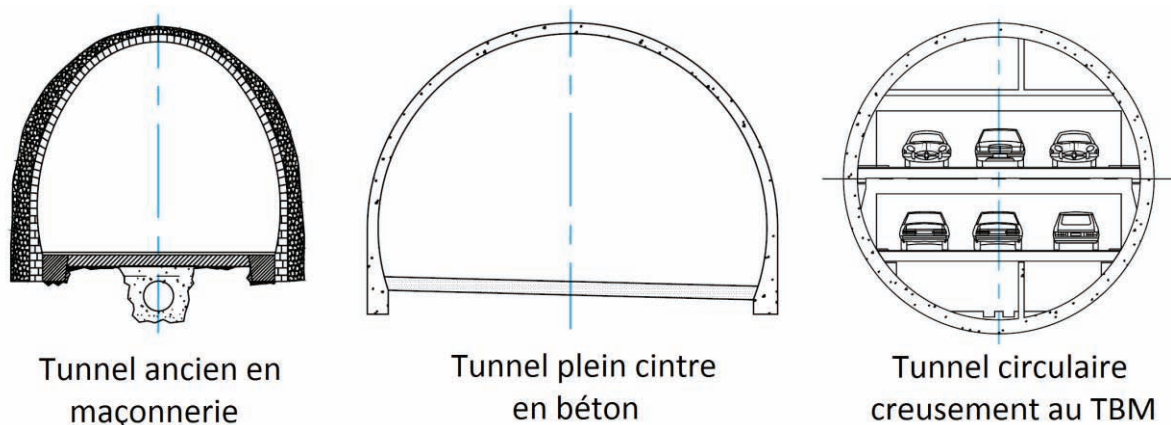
Différents profils en travers de tunnels (CETu, 1998)(TBM : tunnel boring machine)
